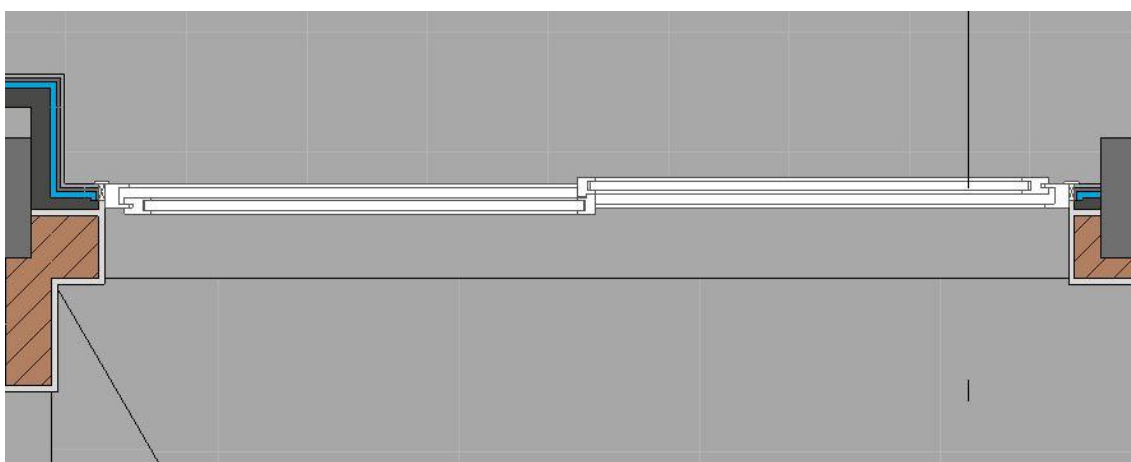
Detalle de la carpintería en Revit. Fuente: Elaboración Propia
